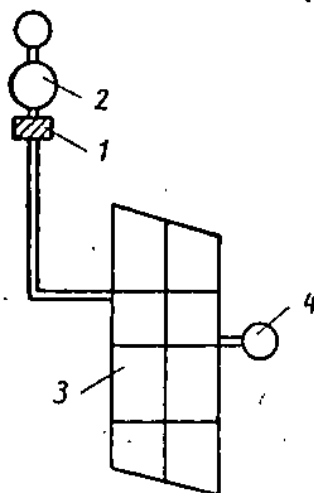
Схема противопожарного водопровода низкого давления (объединенного с хозяйственно-питьевым водопроводом)
